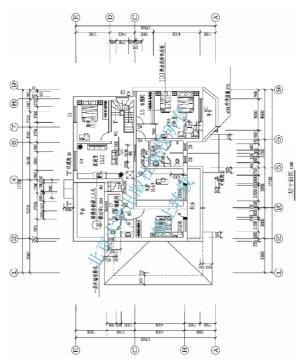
二层平面图(建施 2, 未注明尺寸同建施 1)
